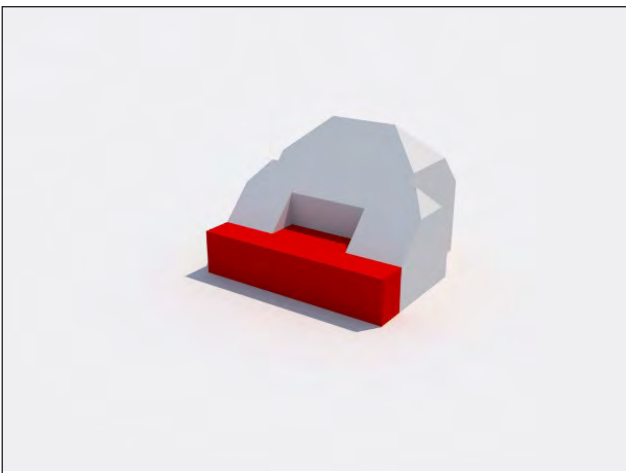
3D-Ansichten der möglichen rückwärtigen Anbauten zum Haustyp B (Doppelhaus mit rückwärtig versetztem Stallanbau)
